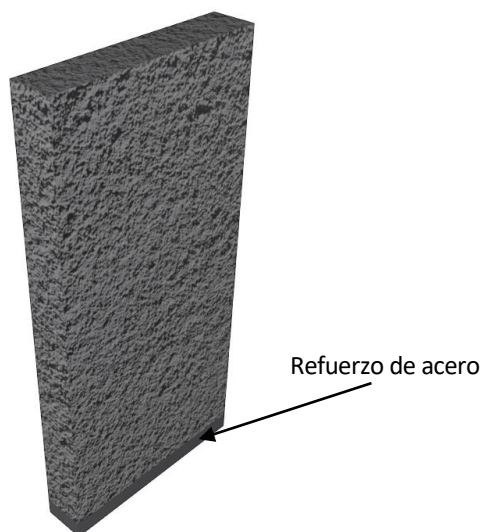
Sección de la viga de hormigón armado con refuerzo de acero.
